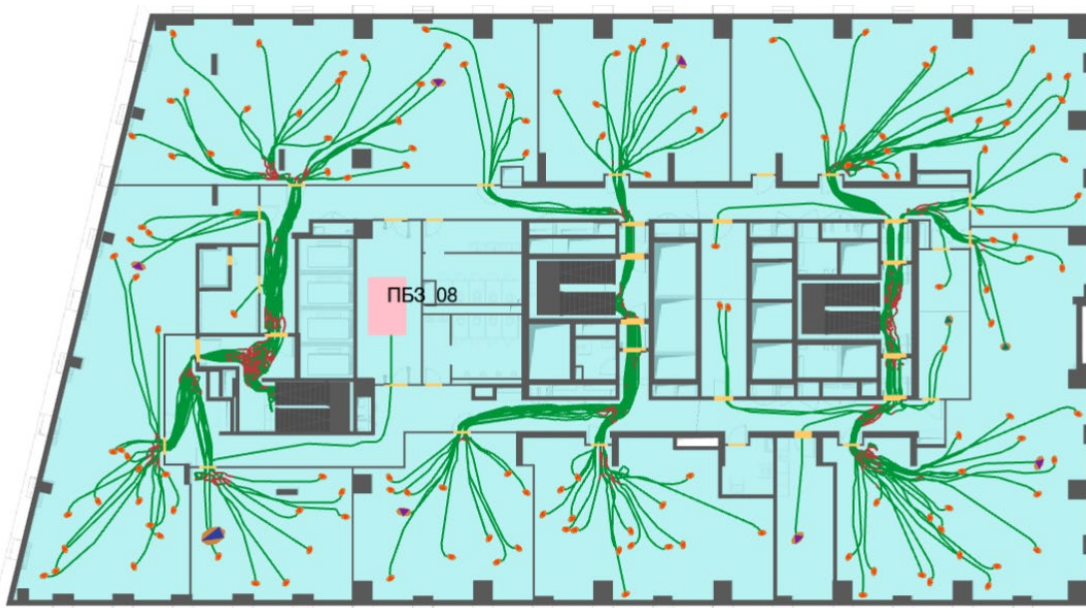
План 8-го этажа и нанесенная на него расчетная (принципиальная) схема эвакуации
